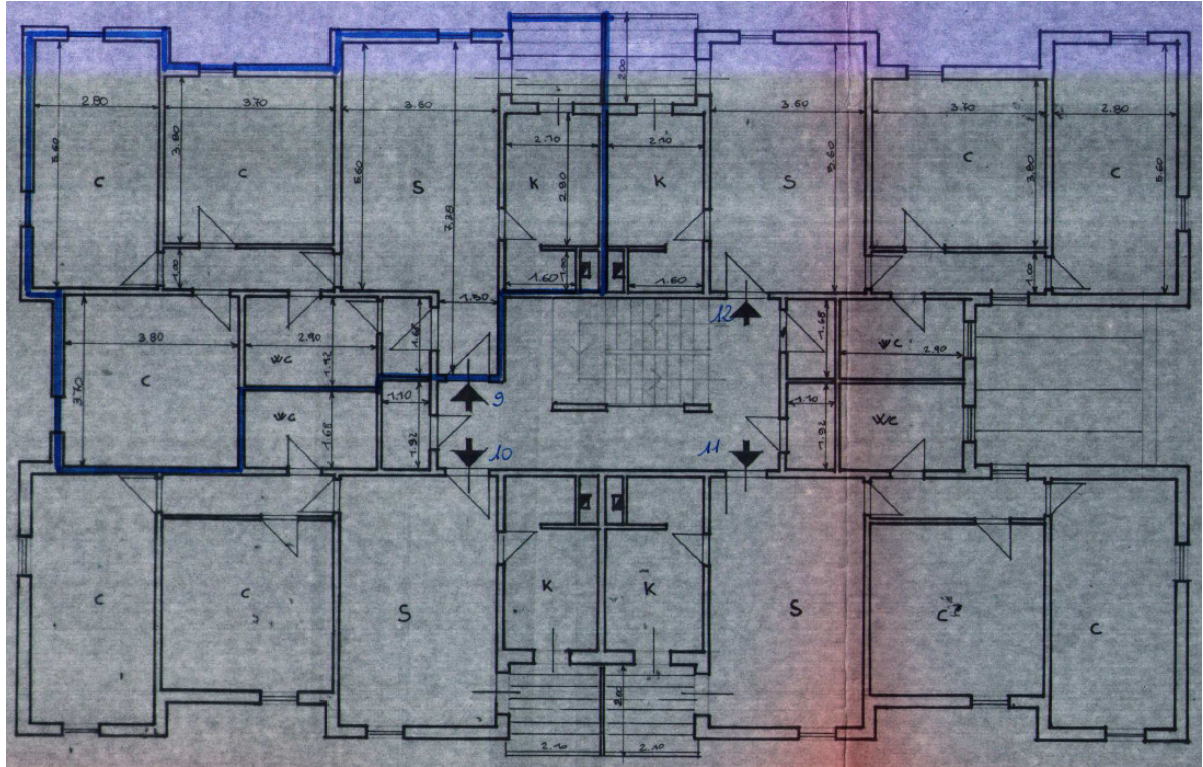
Pianta del piano tipo dell'edificio estratta dalla documentazione del settore Patrimonio dell'ERP Massa Carrara SpA. La pianta è quella di un edificio sostanzialmente simmetrico secondo il piano verticale trasversale e longitudinale, caratterizzato da un vano scala centrale interno. Si riconoscono i setti portanti prefabbricati in corrispondenza dei quali verranno posizionate le colonnine in legno lamellare per il sostegno dei rompitratta delle nuove falde di copertura.
